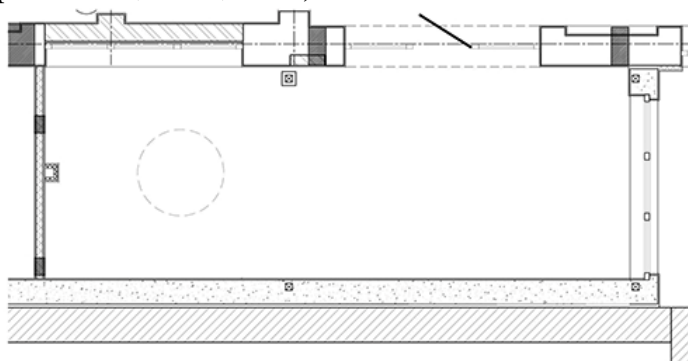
План помещения с круглой формой фонаря верхнего освещения
